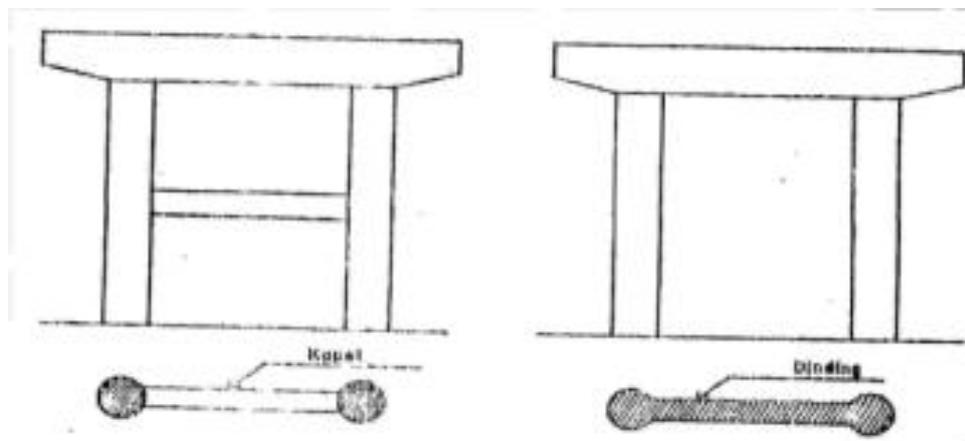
Layout Dinding Pilar Jika Parallel dan Arus yang Menyudut α
